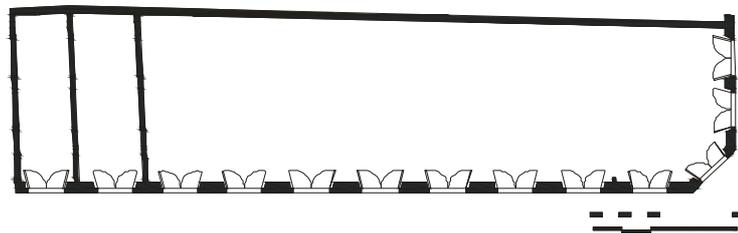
Pavimento térreo da casa à travessa Campos Sales, 251
